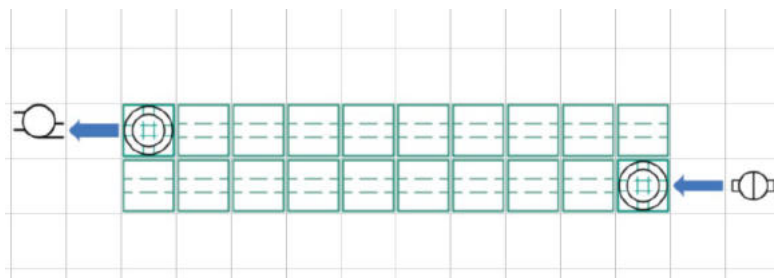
Ausschnitt aus Musterberechnung Rigolenanlage 7 m³; (Fränkische, Drainagesysteme 11/2025), Darstellung unmaßstäblich
